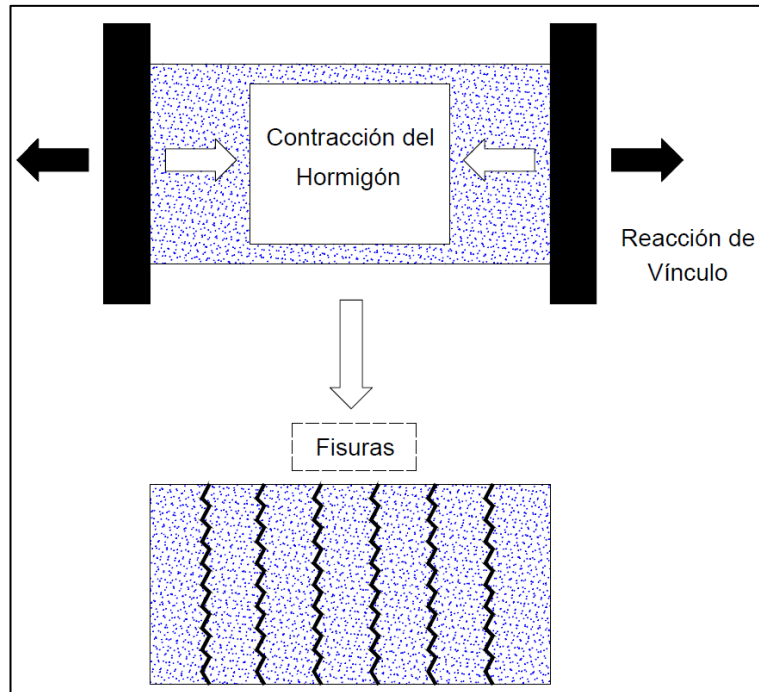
Fisuración por efecto de la contracción impedida.
